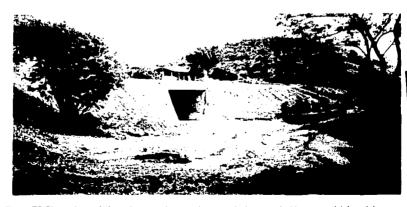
Obra a base de losa de concreto armado proyectada y construida para colchón mínimo
